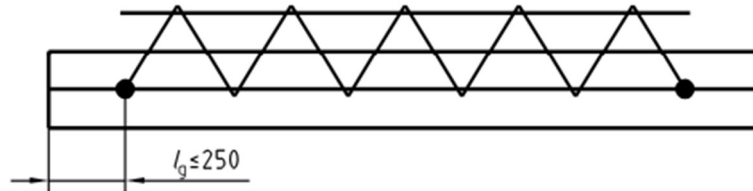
posizionamento longitudinale della trave a traliccio
